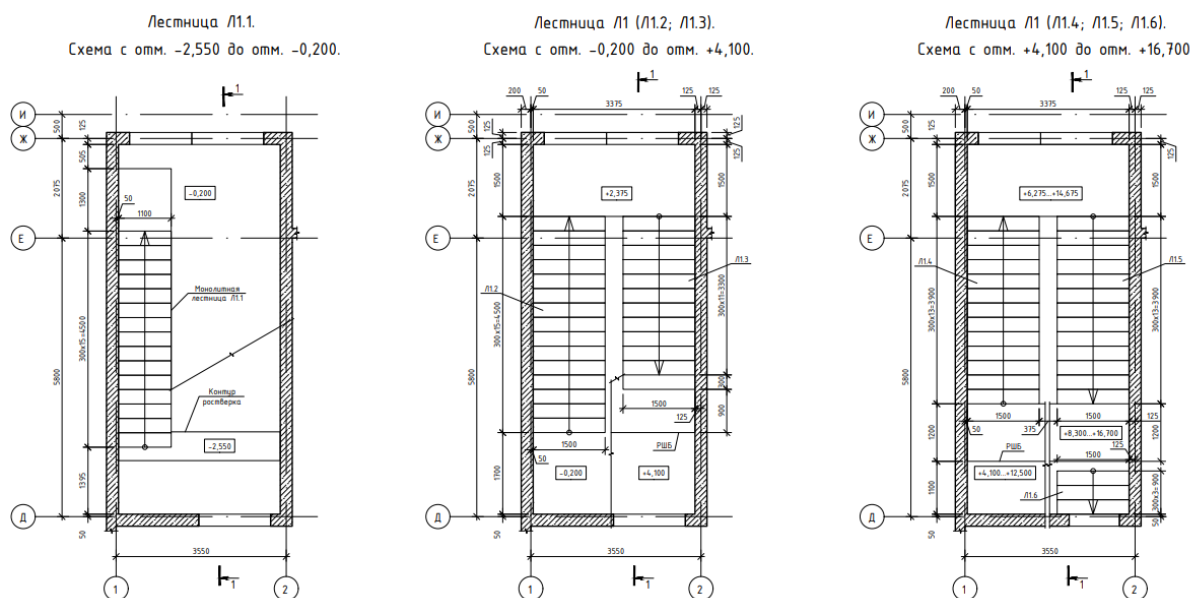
Схемы лестниц 1,2,3 этажей
